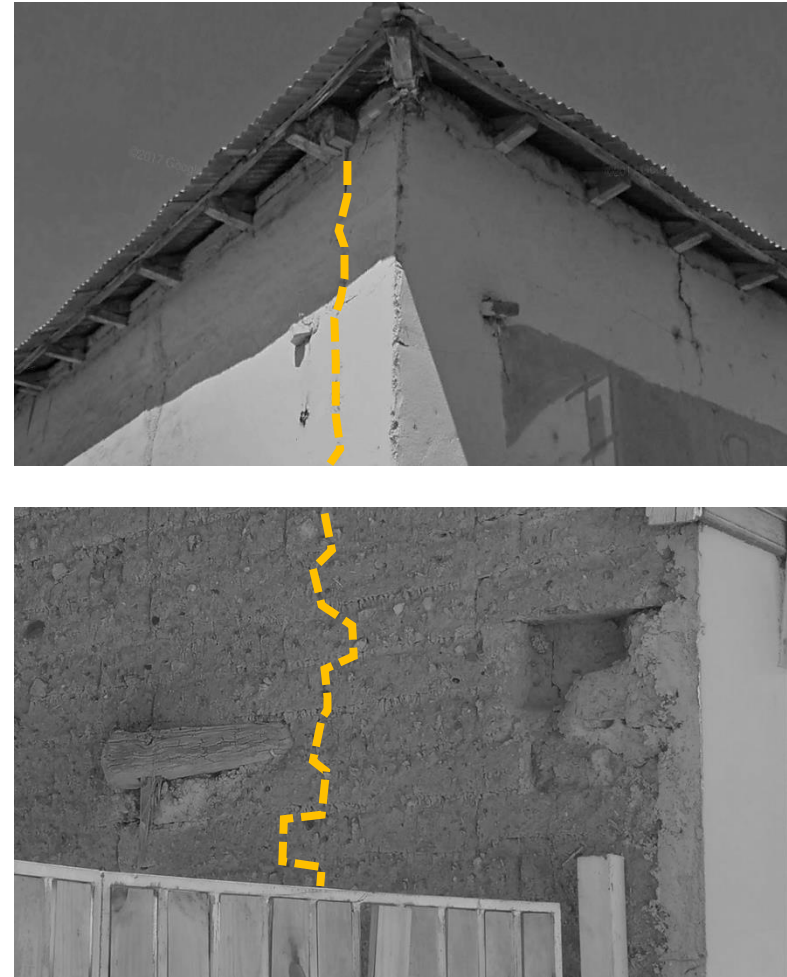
Fisuras y grietas comunes asociadas a los "dispositivos DE".
